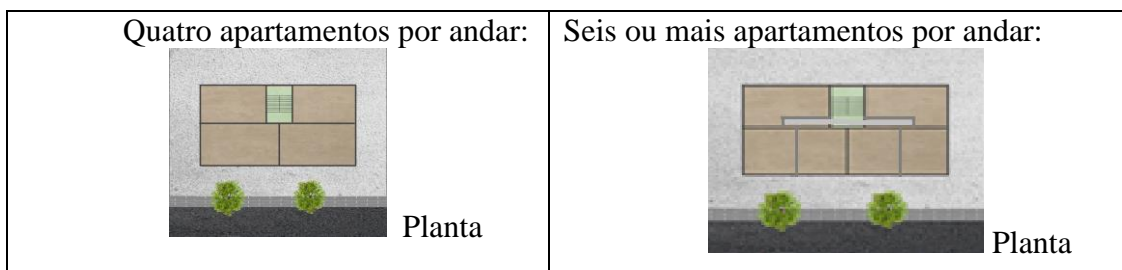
Posição geométrica dos apartamentos no pavimento tipo
